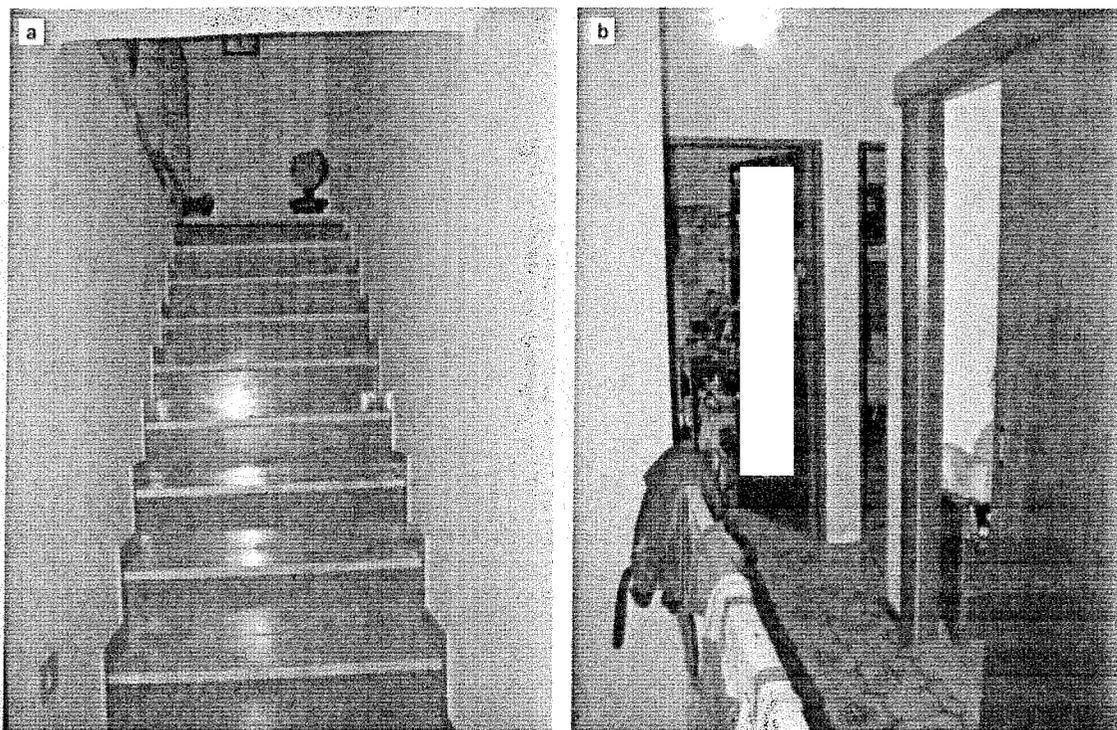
a) Scala di collegamento interna tra piano primo e piano secondo; b) Disimpegno al piano secondo.
